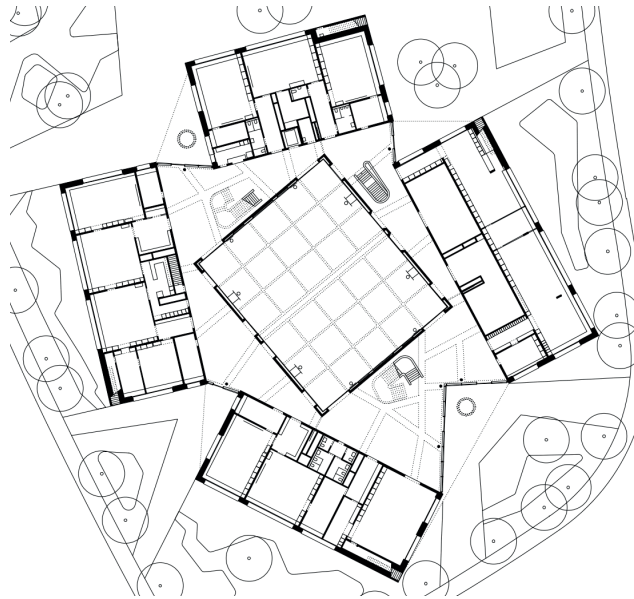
Adrian Streich Architekten, Zinzikon Schoolhouse
